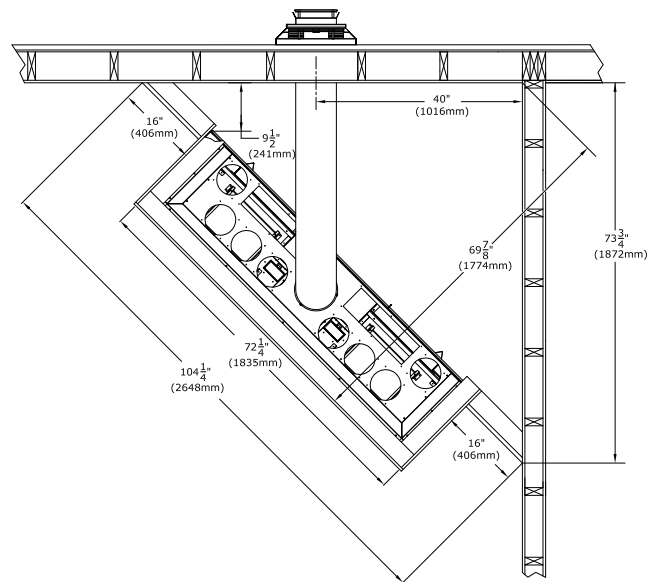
Installations typiques du foyer à 3 faces vitrées (foyer panoramique)
